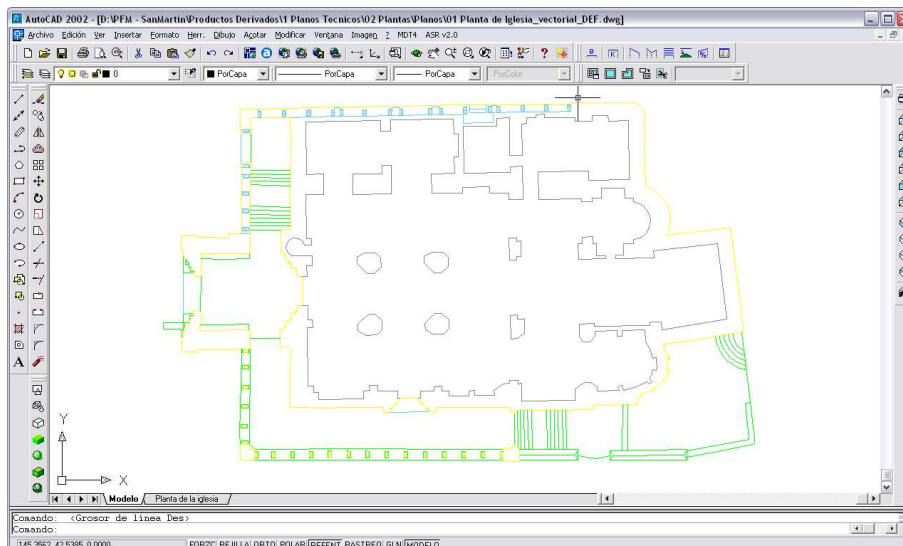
las líneas del interior y del exterior de la planta de la iglesia
